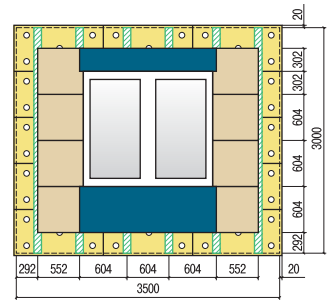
Плита с готовым навесным вентилируемым фасадом
